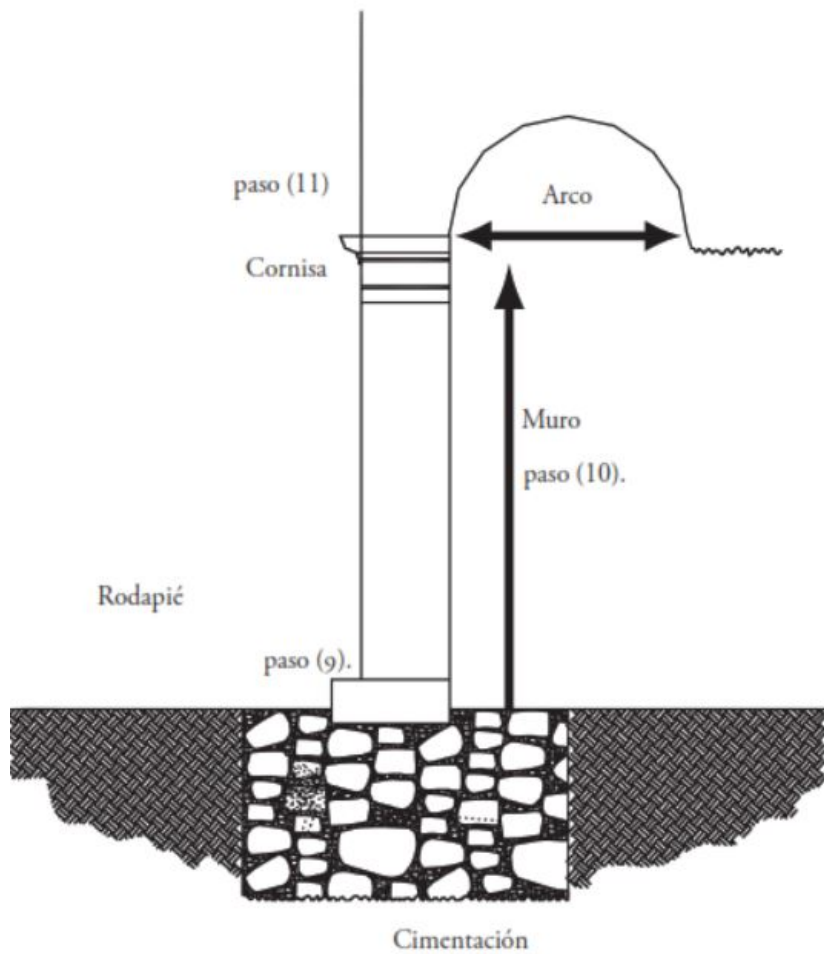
Disposiciones para la construcción, vista en elevación. Tomado de (Ruiz, 2007)
